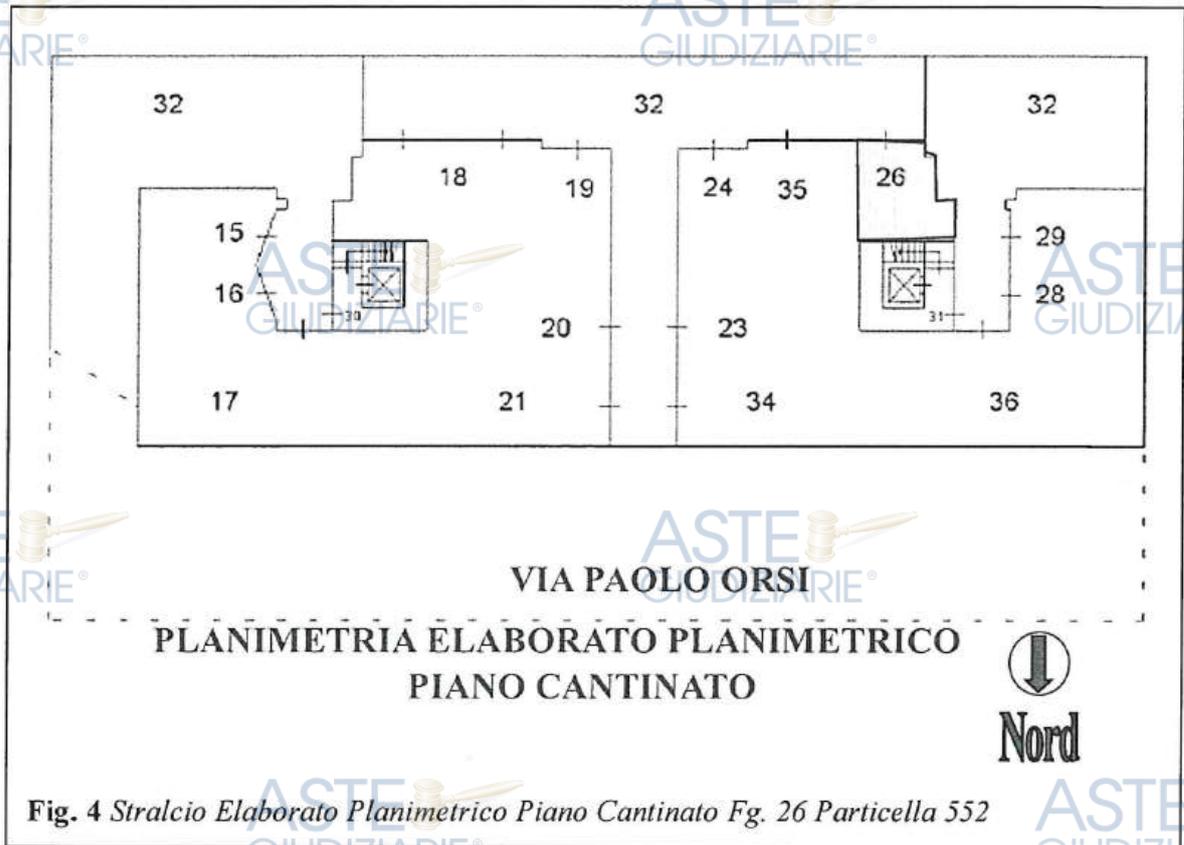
Stralcio Elaborato Planimetrico Piano Cantinato Fig. 26 Particella 552
